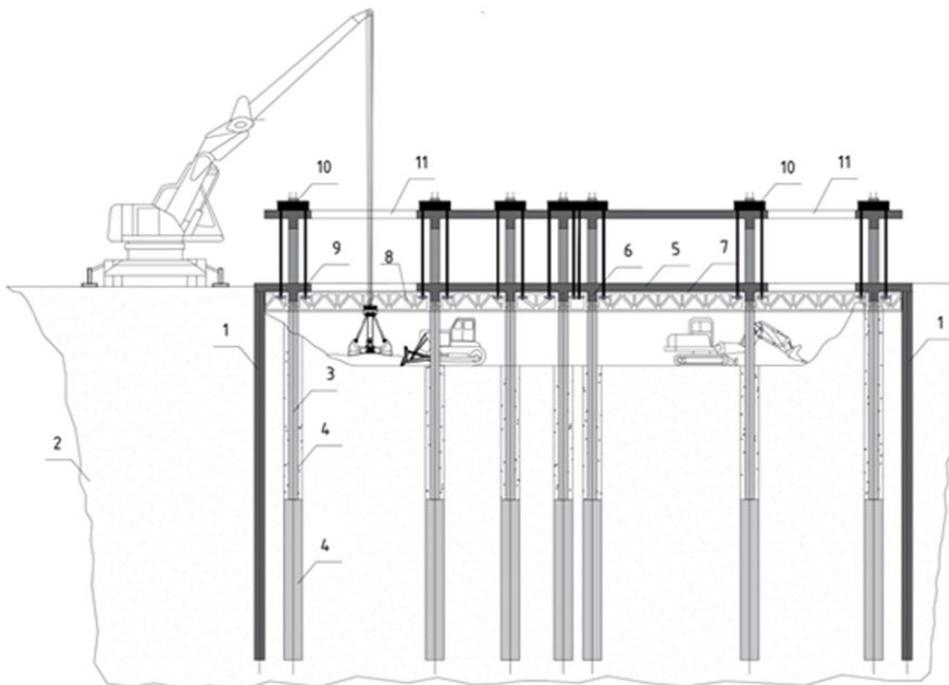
Технологическая схема разработки и транспортировки грунта в пространстве будущего верхнего этажа подземной части здания
